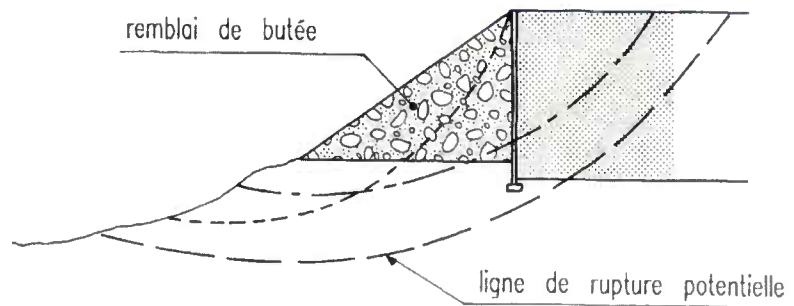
Effets pouvant être induits par l'action pondérale de remblais rapportés
